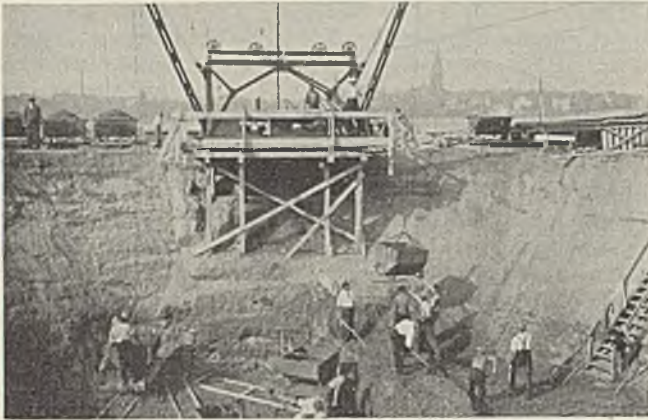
Ausschachtung der Baugrube mit Doppelkran. 10. August 1936.
